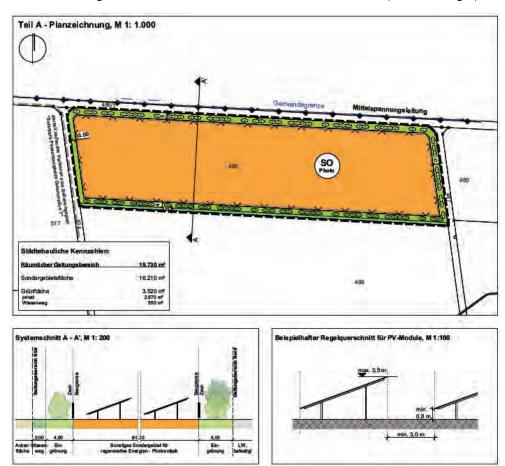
Ausschnitt Planzeichnung B-Plan "Solarpark Pessenburgheim Stöckl" (becker + haindl, Entwurf 17.10.2023)
